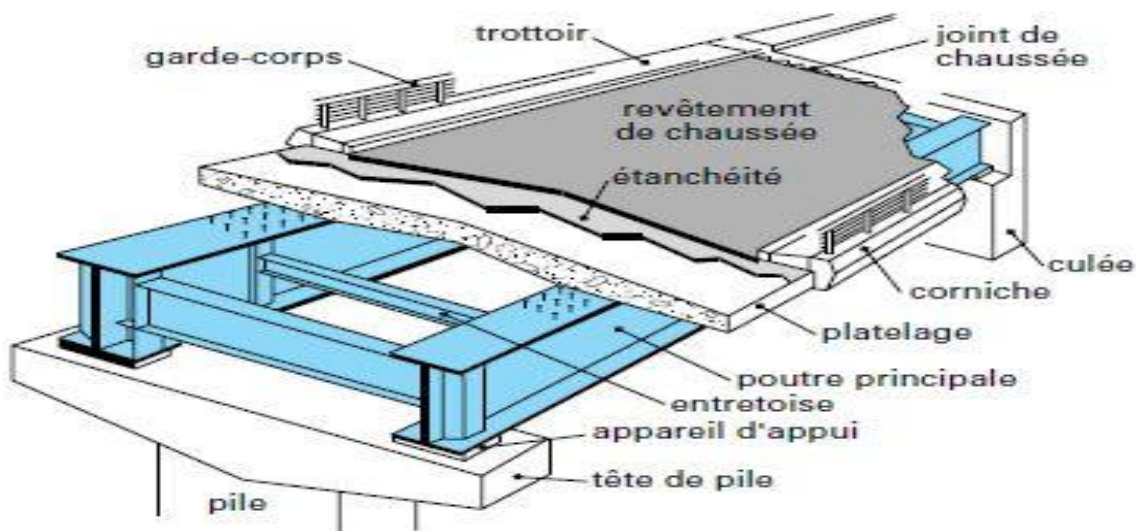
Eléments constitutifs d'un pont à poutres sous chaussées
